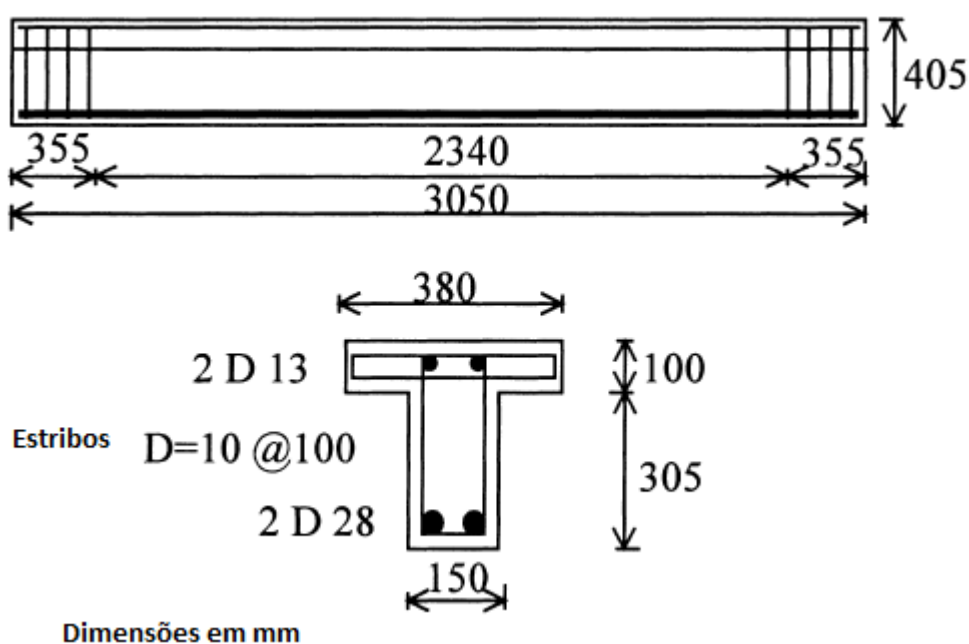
Detalhe das vigas estudadas (Khalifa *et al.* 1999).
